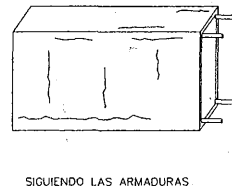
Tipología de grietas en elementos estructurales.
